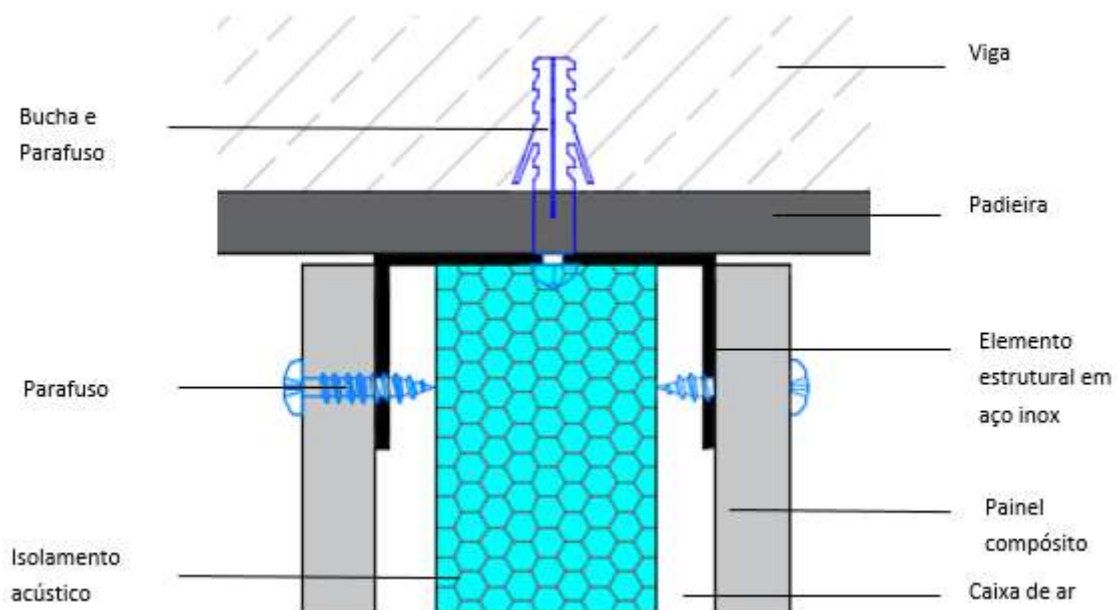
Secção vertical da parede divisória na aplicação em paredes.
